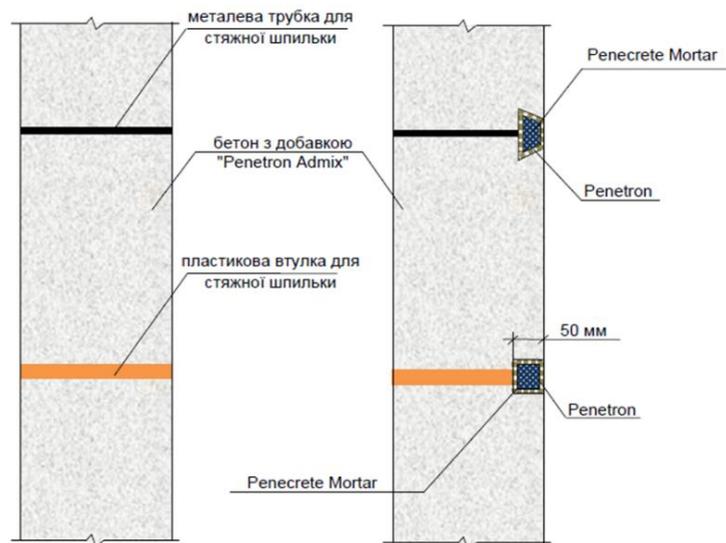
Схема улаштування гідроізоляції отворів в бетоні від стяжних шпильок опалубки
